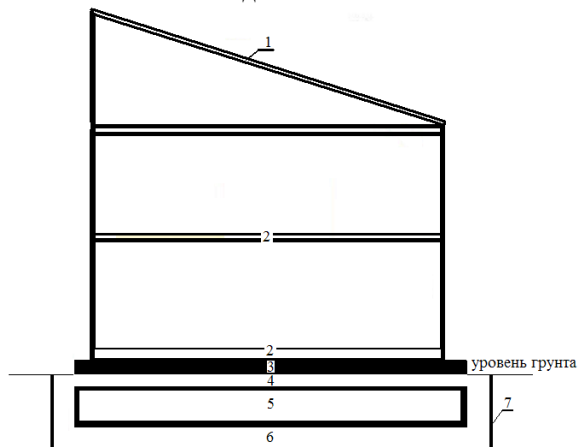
Эскиз конструкции здания. 1 – крыша дома с СВК; 2 – тёплые полы; 3 – фундаментная плита дома; 4 – теплоизоляция; 5 – САТ; 6 – эластичная теплоизоляция; 7 – наружное ограждение САТ
